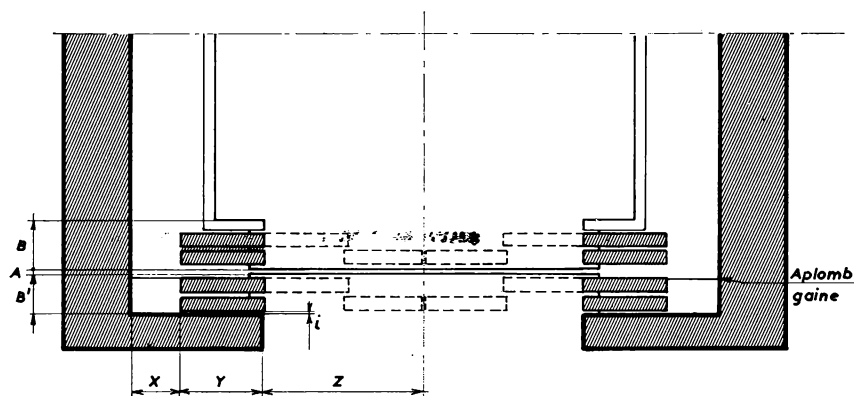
Travaux de maçonnerie pour implantation de porte coulissante à quatre vantaux télescopiques à ouverture centrale (même porte sur cabine).
